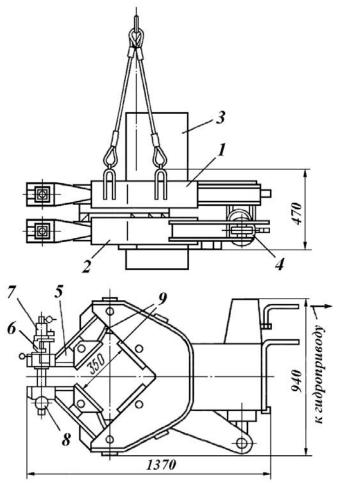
Схема устройства для скручивания железобетонных свай
